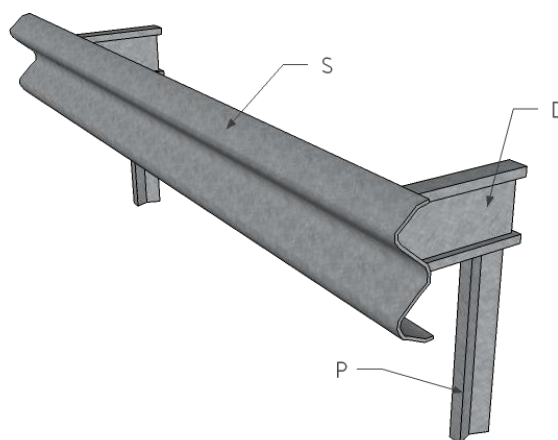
Estructura de W en guardarrailes. [Fuente: Wikipedia: Traffic barrier]
